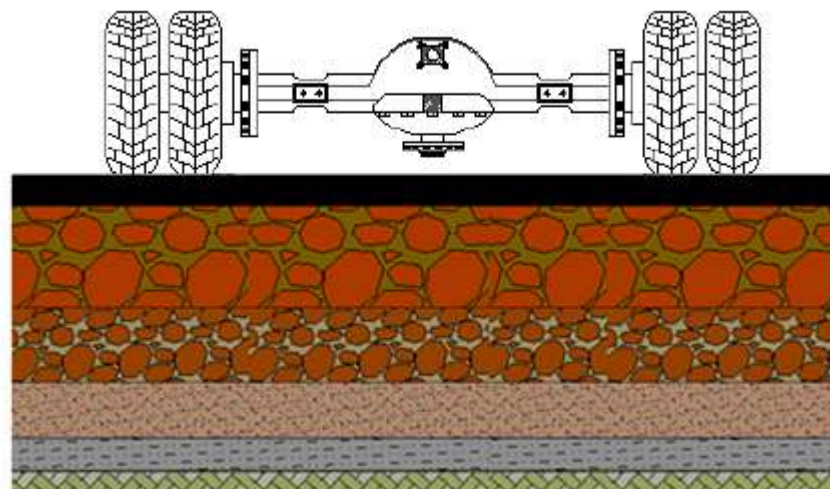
Sección estructural típica de un pavimento flexible bajo acción vehicular.
